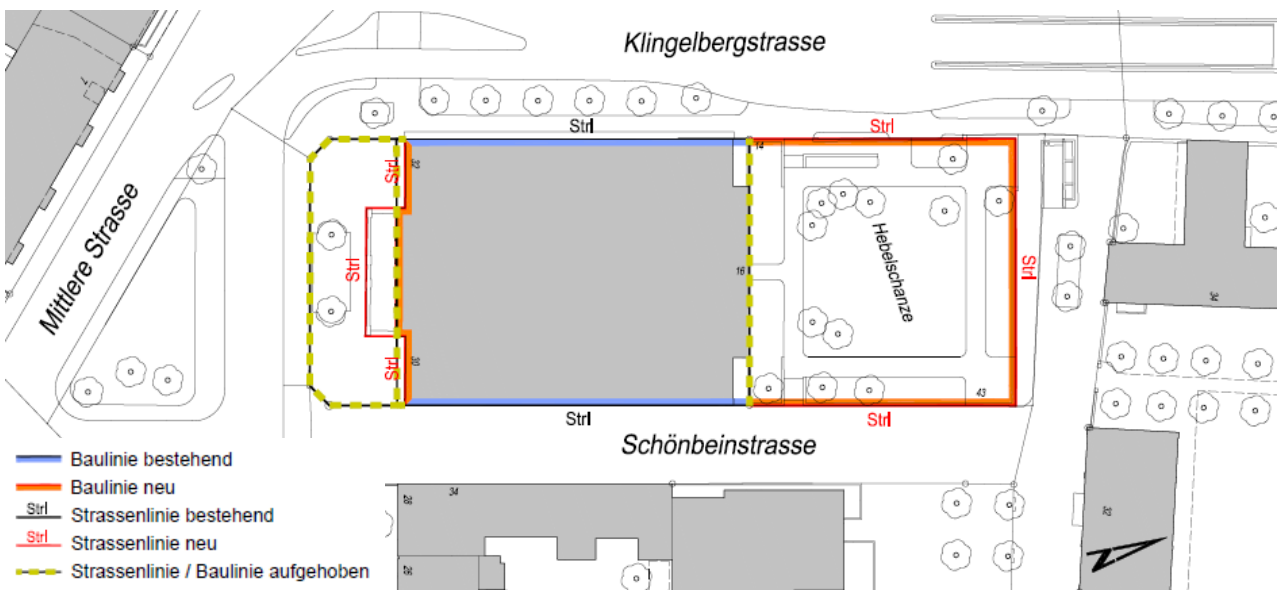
Plan-Nr. 14'525 / Bau- und Strassenlinienplan (nicht genordet)
